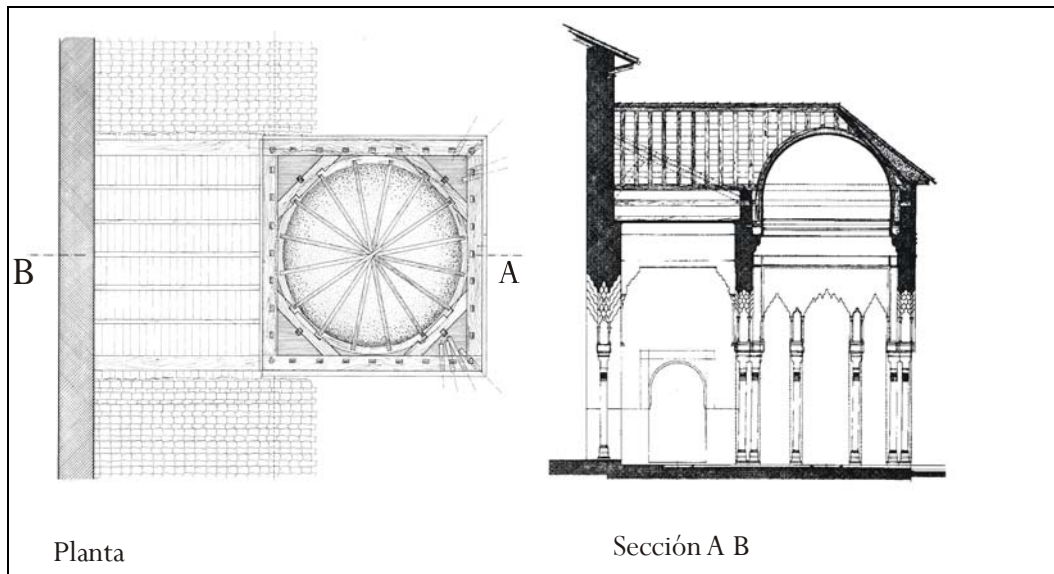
Planta y sección del templete oeste (Sala de Mocárabes). Tomados de los Planos n° nuevo 2.557 y 2.558 respectivamente de la Sección de Mapas, Planos y Dibujos del Archivo Central del Patronato de la Alhambra.
